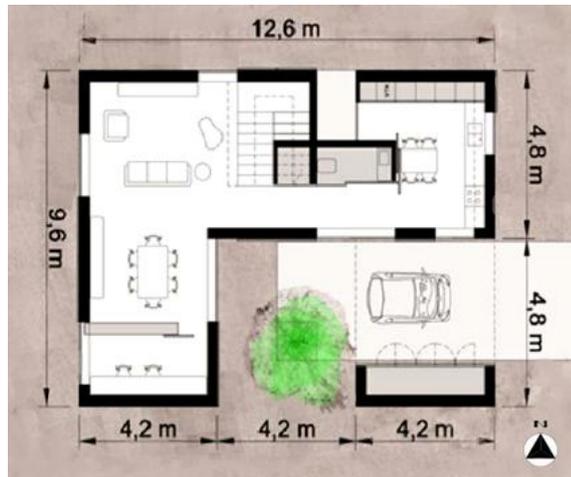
Planta do piso térreo da habitação unifamiliar em Kiruna
